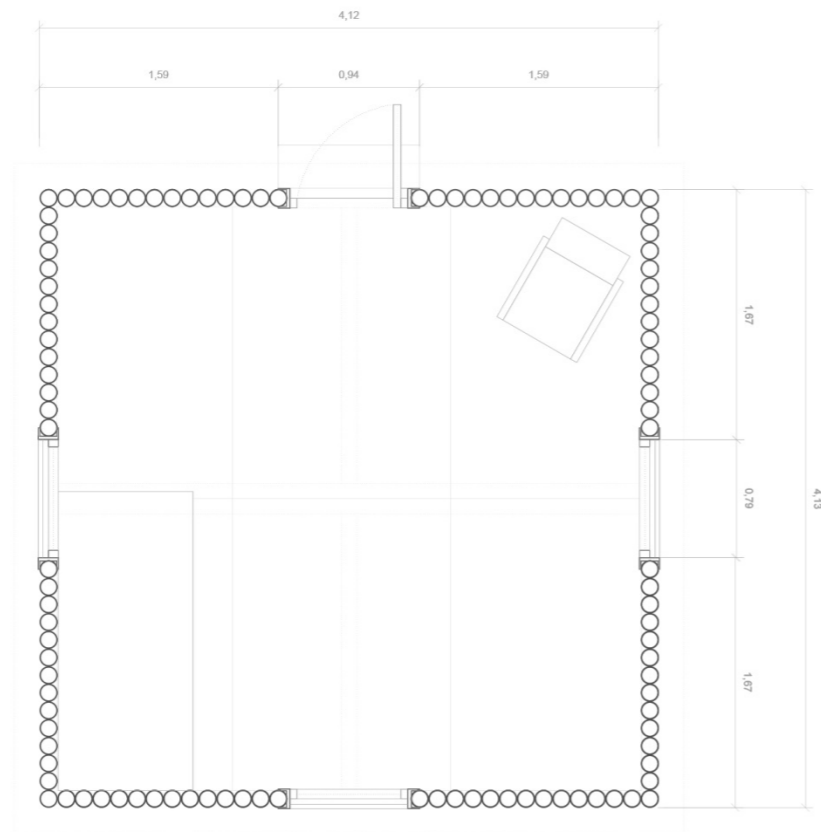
Planta Paper Log House. E:1/50. Elaboración propia.
